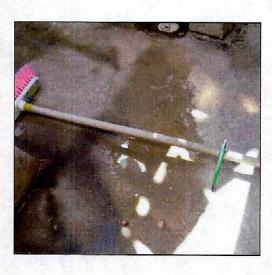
Desplazamiento del muro del patio de la casa de la Cra. 72 # 68A-20 Sur
